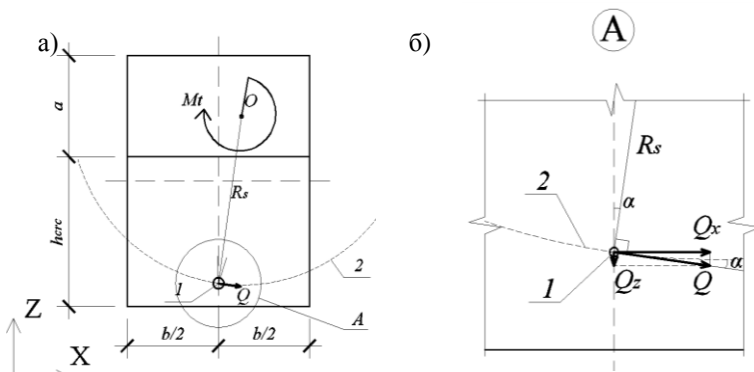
Схема сечения балки в месте нормальной трещины для определения нагельной силы в случае смещения центра вращения с геометрической вертикальной оси: а) общая схема сечения; б) узел с нагельным усилием в арматуре
